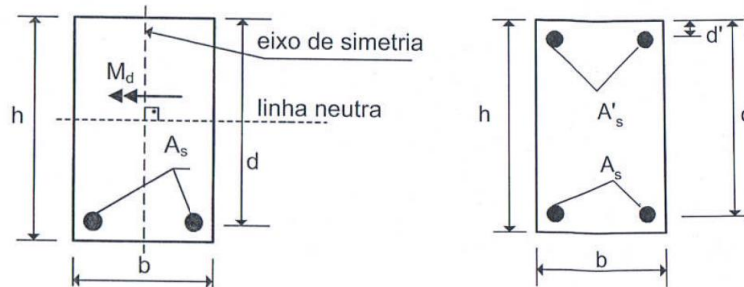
Disposições dos elementos da seção transversal de uma viga de concreto armado. (Fonte: ARAÚJO, 2014).
